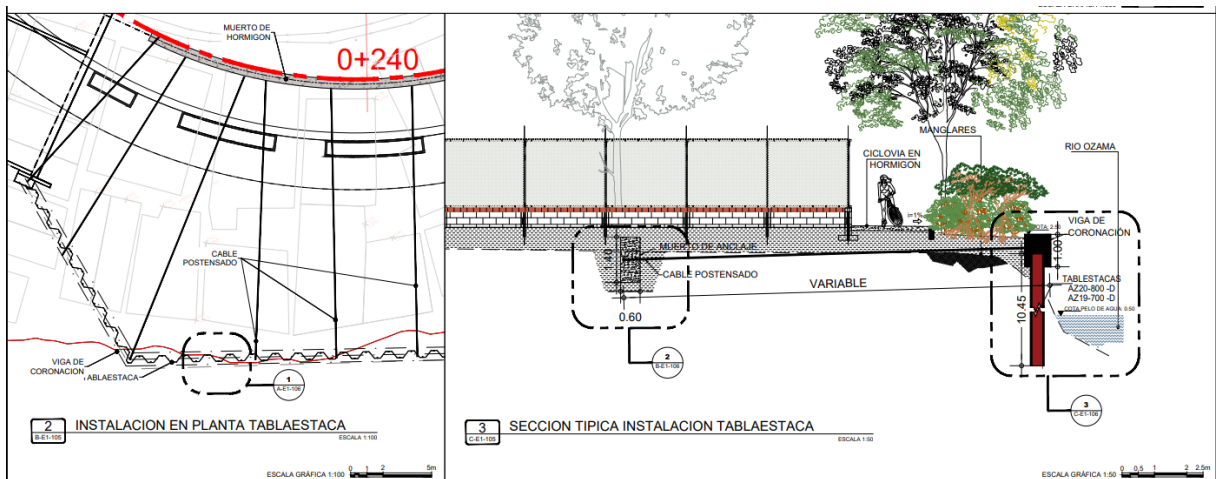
Detalle de construcción de tablaestacado en Las Lilas Etapa 01. Fuente: URBE, octubre 2025.
